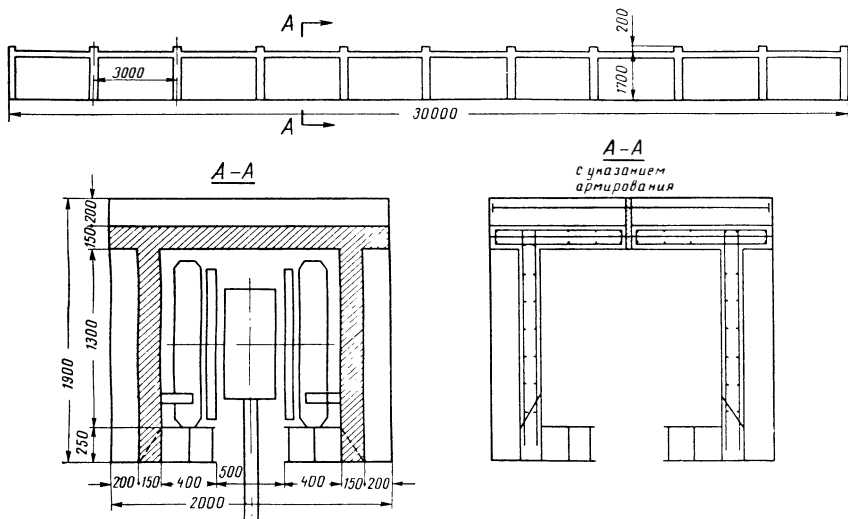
Конструкция металло-железобетонной закрытой балки (проект Промтранснипроекта)
